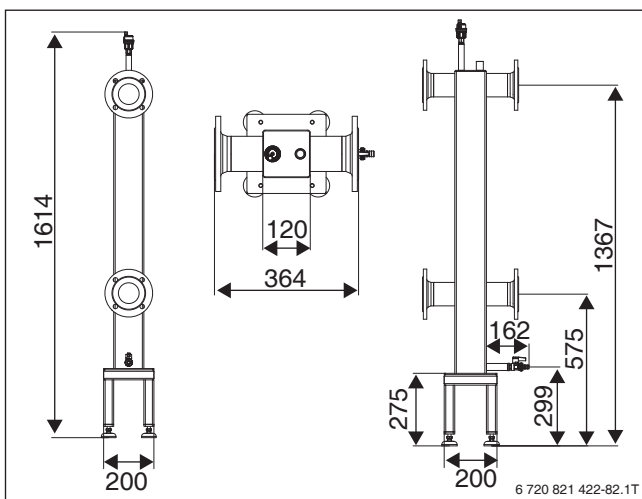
Weichengruppe für 2-Kessel-Kaskade 2 × 200 kW, 2 × 250 kW oder 2 × 300 kW
